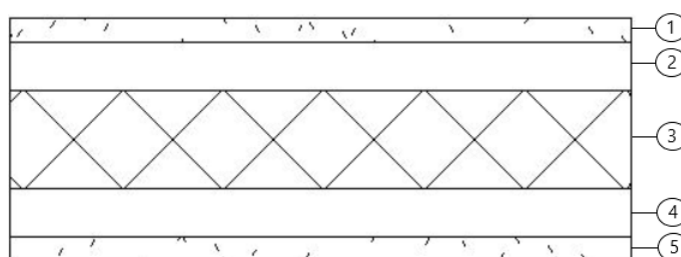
Pormenor da constituição da parede interna tipo I1
